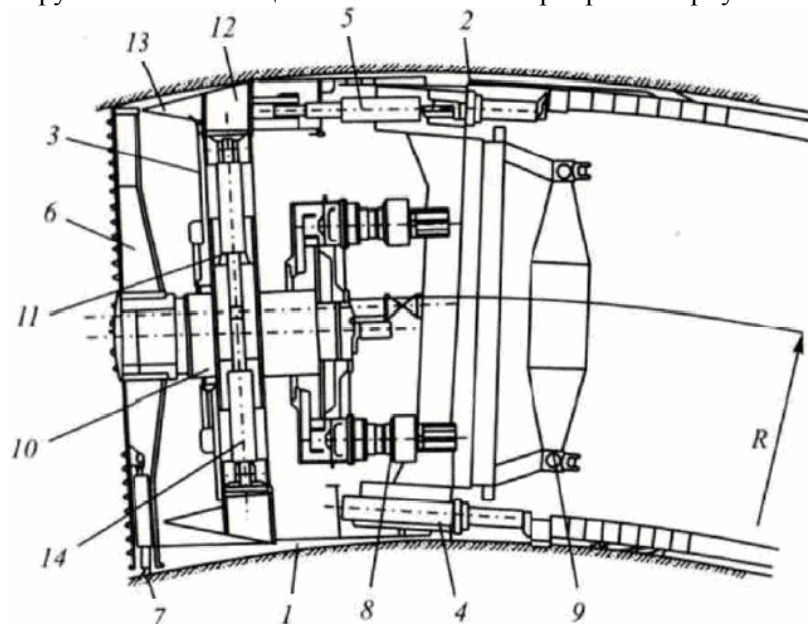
Конструктивная схема щитовой машины с шарнирным корпусом второго вида
